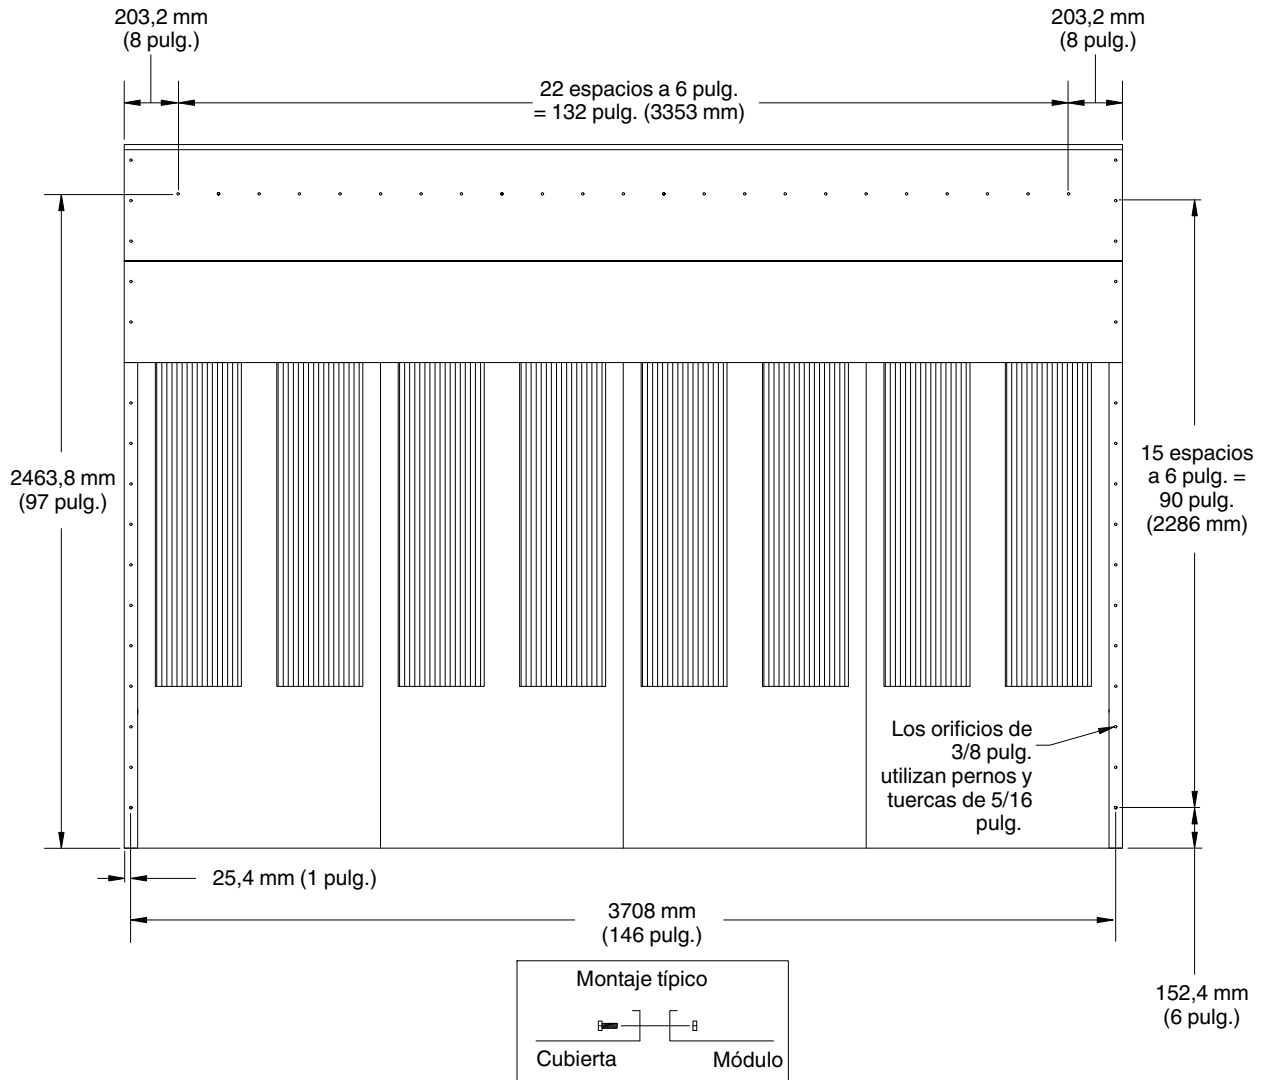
Dimensiones de montaje de módulo de 10.000 y 12.000 pcm a cubierta
